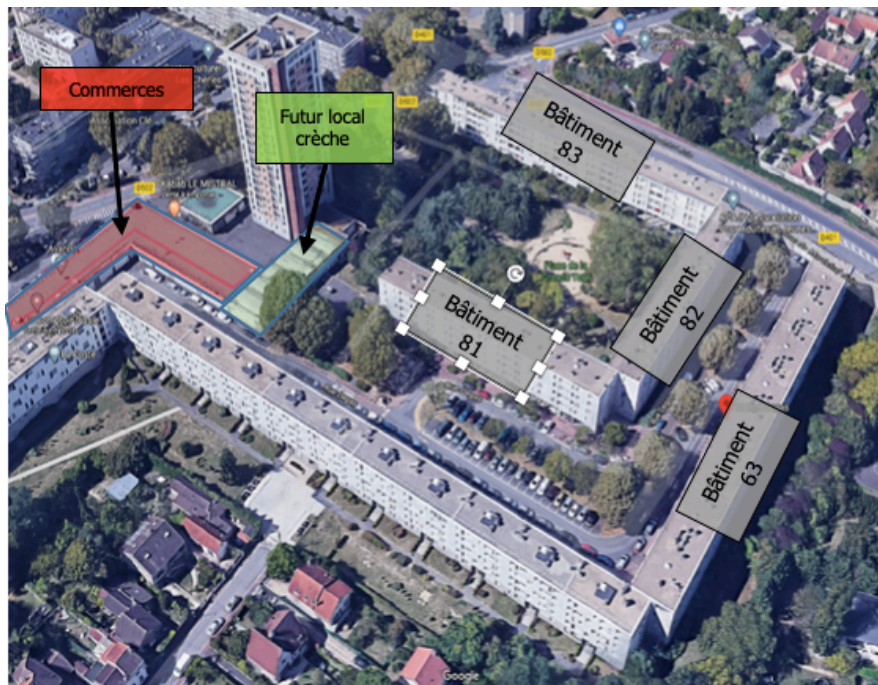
Plan de situation du projet. Réalisé par l'auteur. Extrait de Google Earth
